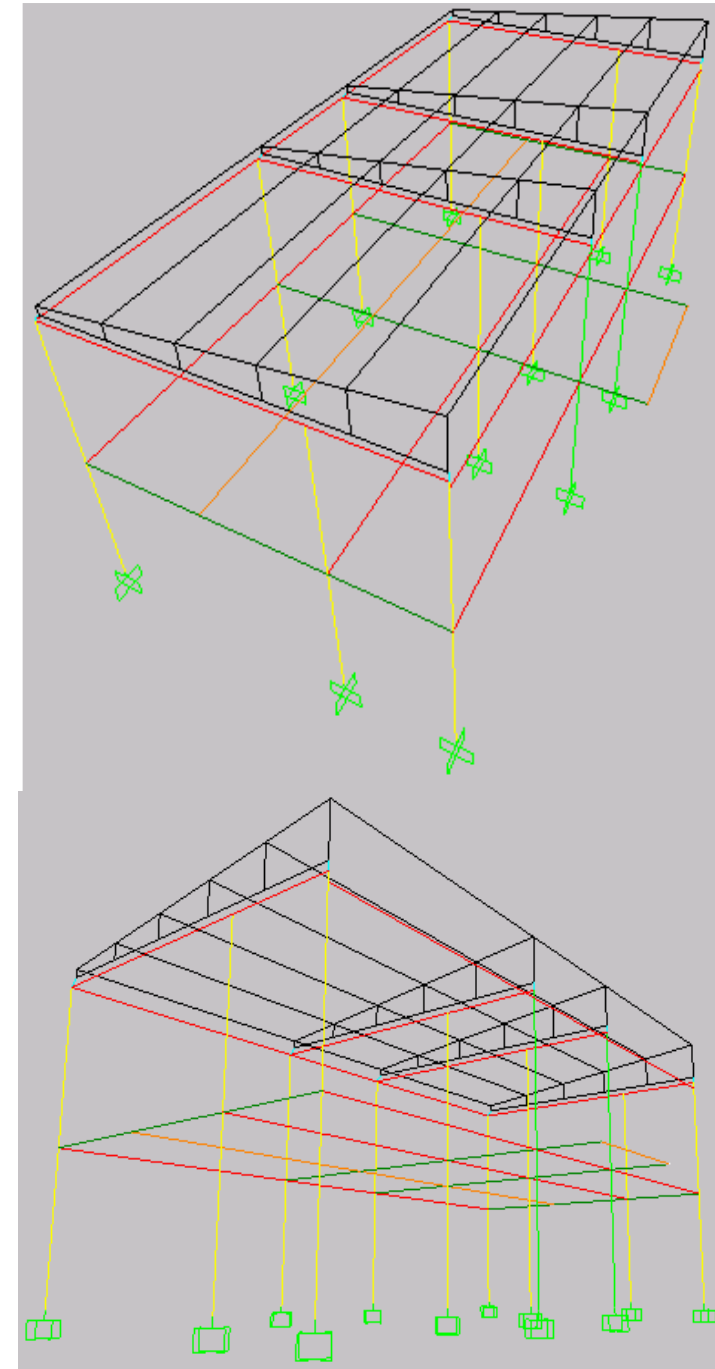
Vista general en planta e inferior del bloque tres modelado con secciones
